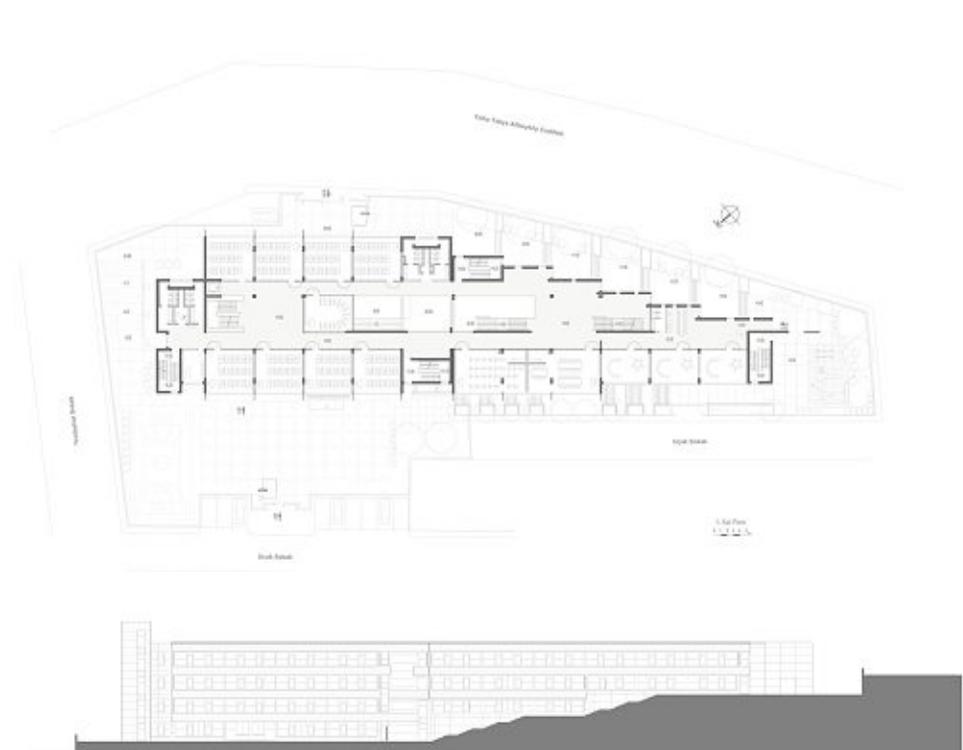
Grundriss 1.Obergeschoss, Nordwestansicht
